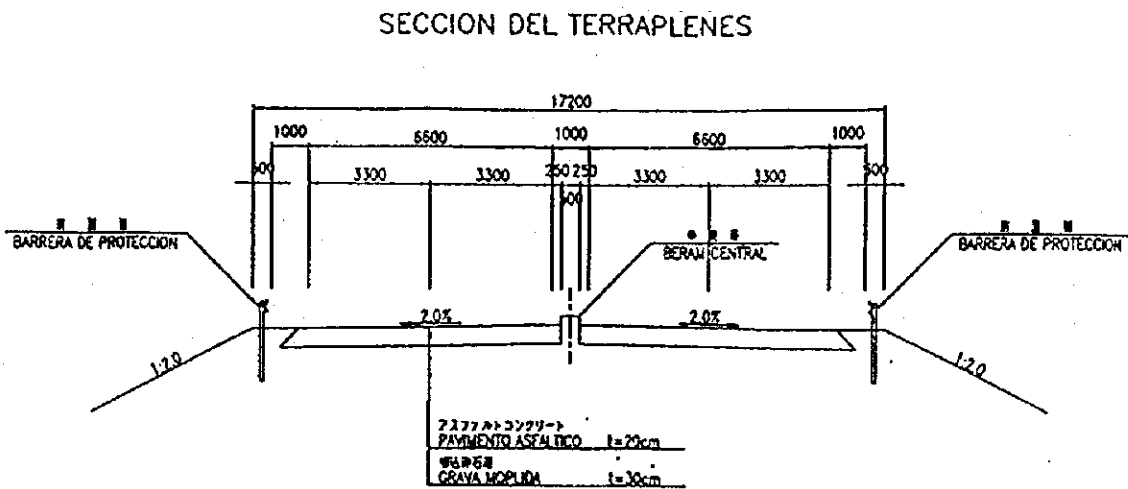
Sección Transversal Estándar de la Vía (lado sur)
